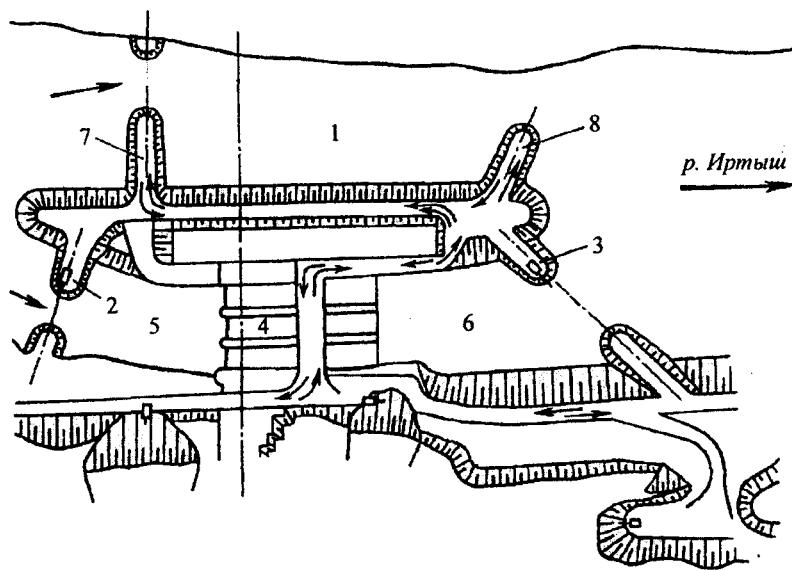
Схема перекрытия р. Иртыш на Бухтарминской ГЭС пионерным способом при пропуске строительных расходов секционированием русла: 1 – перекрываемое русло; 2 – ВП – верхняя перемычка, 3 – НП – нижняя перемычка, 4 – БС – бетонные сооружения – гребенка водосливной плотины, 5 и 6 – Квб и Кнб – соответственно, котлованы верхнего и нижнего бьефов плотины; 7 и 8 – верхней и нижней banquetы перекрытия
